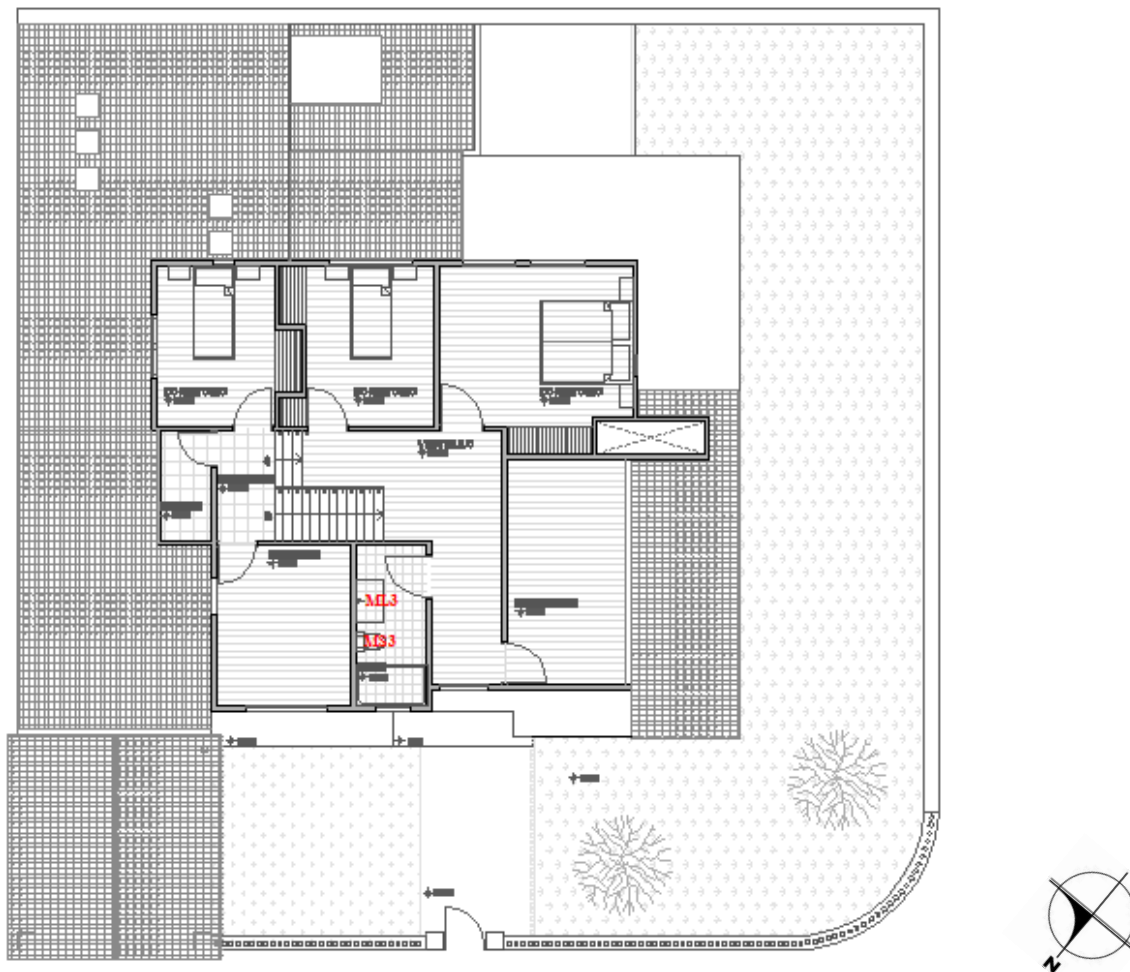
Planta segundo nivel lugares en donde se instaló medidores
